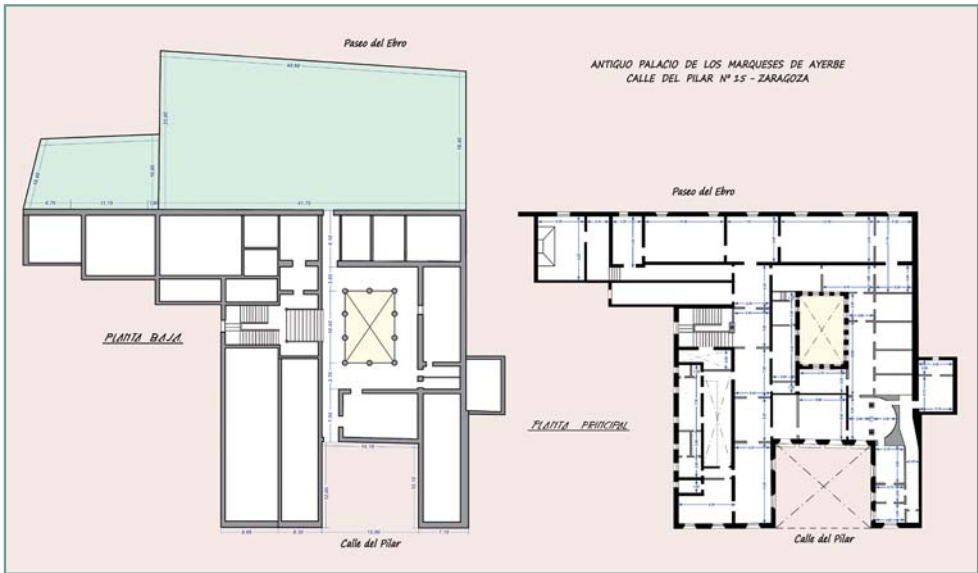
Plano de las plantas baja y principal de la casa del Marqués de Ayerbe en el momento de su derribo (mediciones realizadas por M.Á. Navarro).
